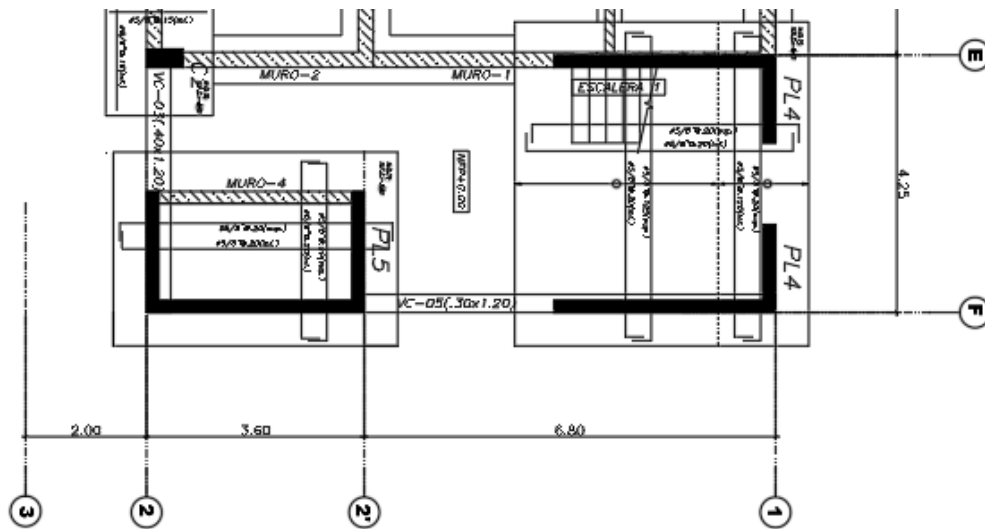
Viga de cimentación VC-05 para sistema de muros
